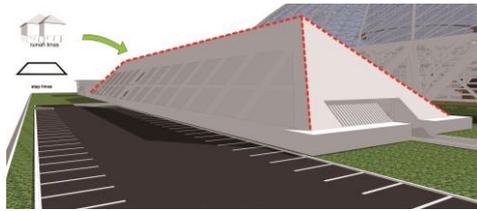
Bentuk Massa Fasilitas *Workshop
